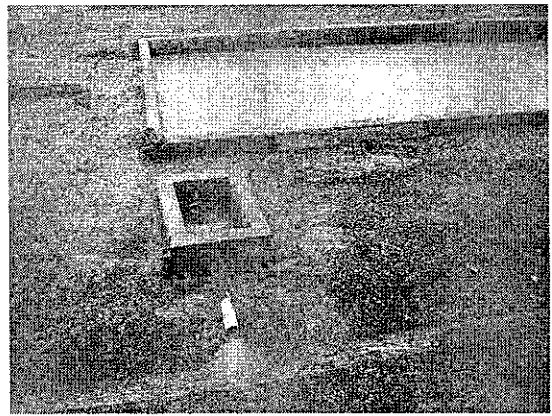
Lote 27/SC – Jazida J-5 – Retirada de tanques de abastecimento – derramamento de óleo.
